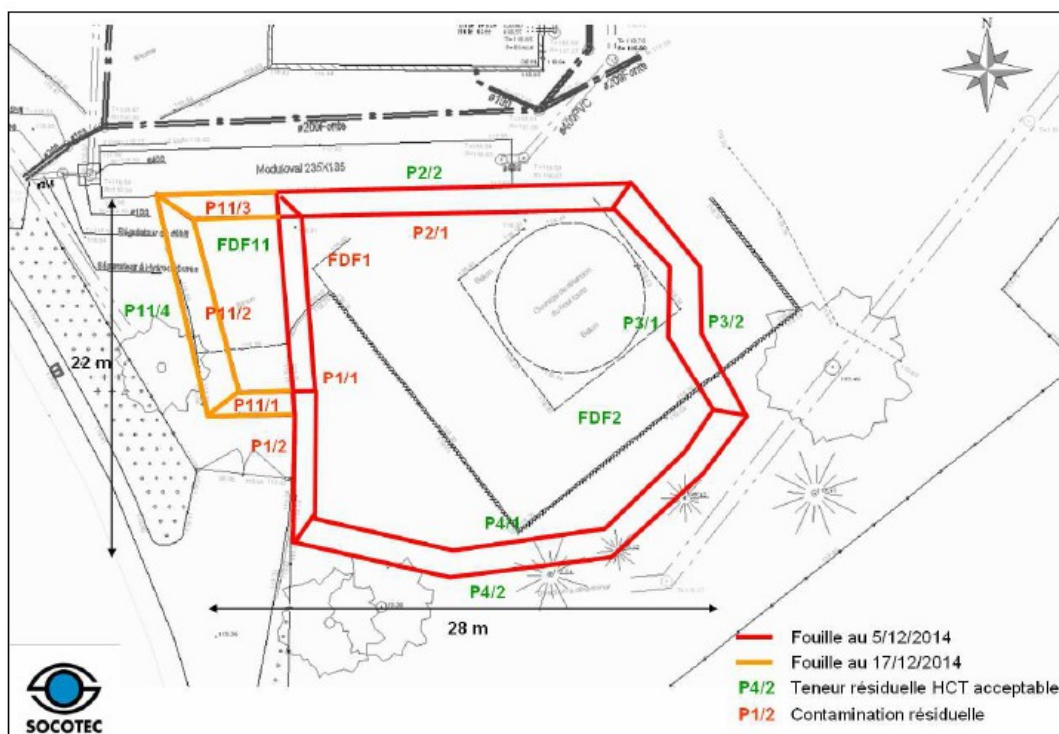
SCHEMA DE LA ZONE EXCAVEE ET LOCALISATION DES PRELEVEMENTS EN PAROIS ET FONDS DE FOUILLE
